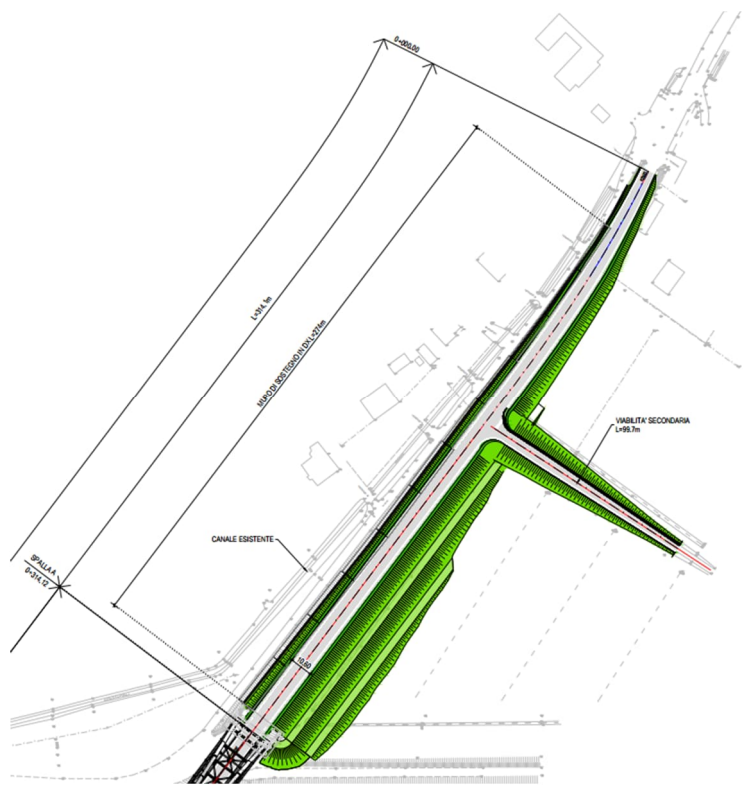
Stralcio planimetrico dell'approccio nord, con indicazione dell'estensione del muro di sottoscarpa
